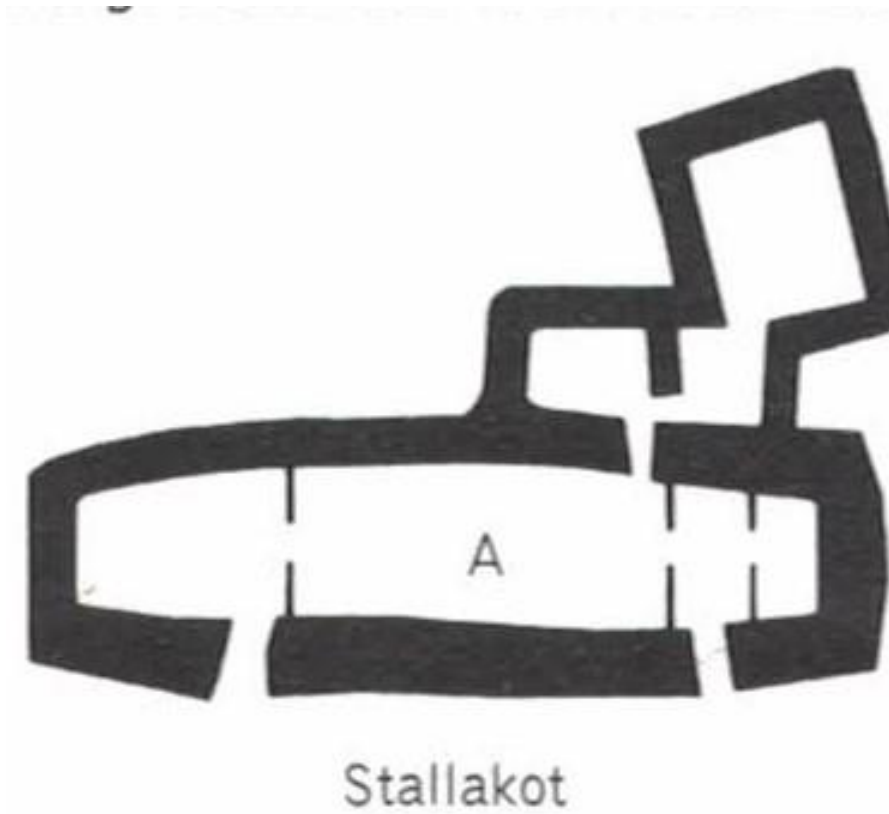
plan de la maison de Stallakot. A : SKáli. Source : Abrecht 2000 : 10.
